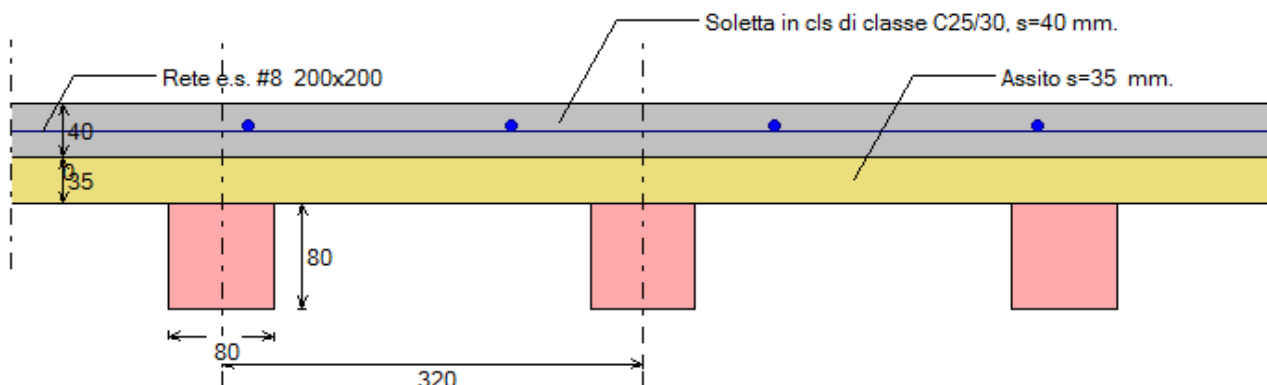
Grafica: Sezione B-B (sezione del travetto)
